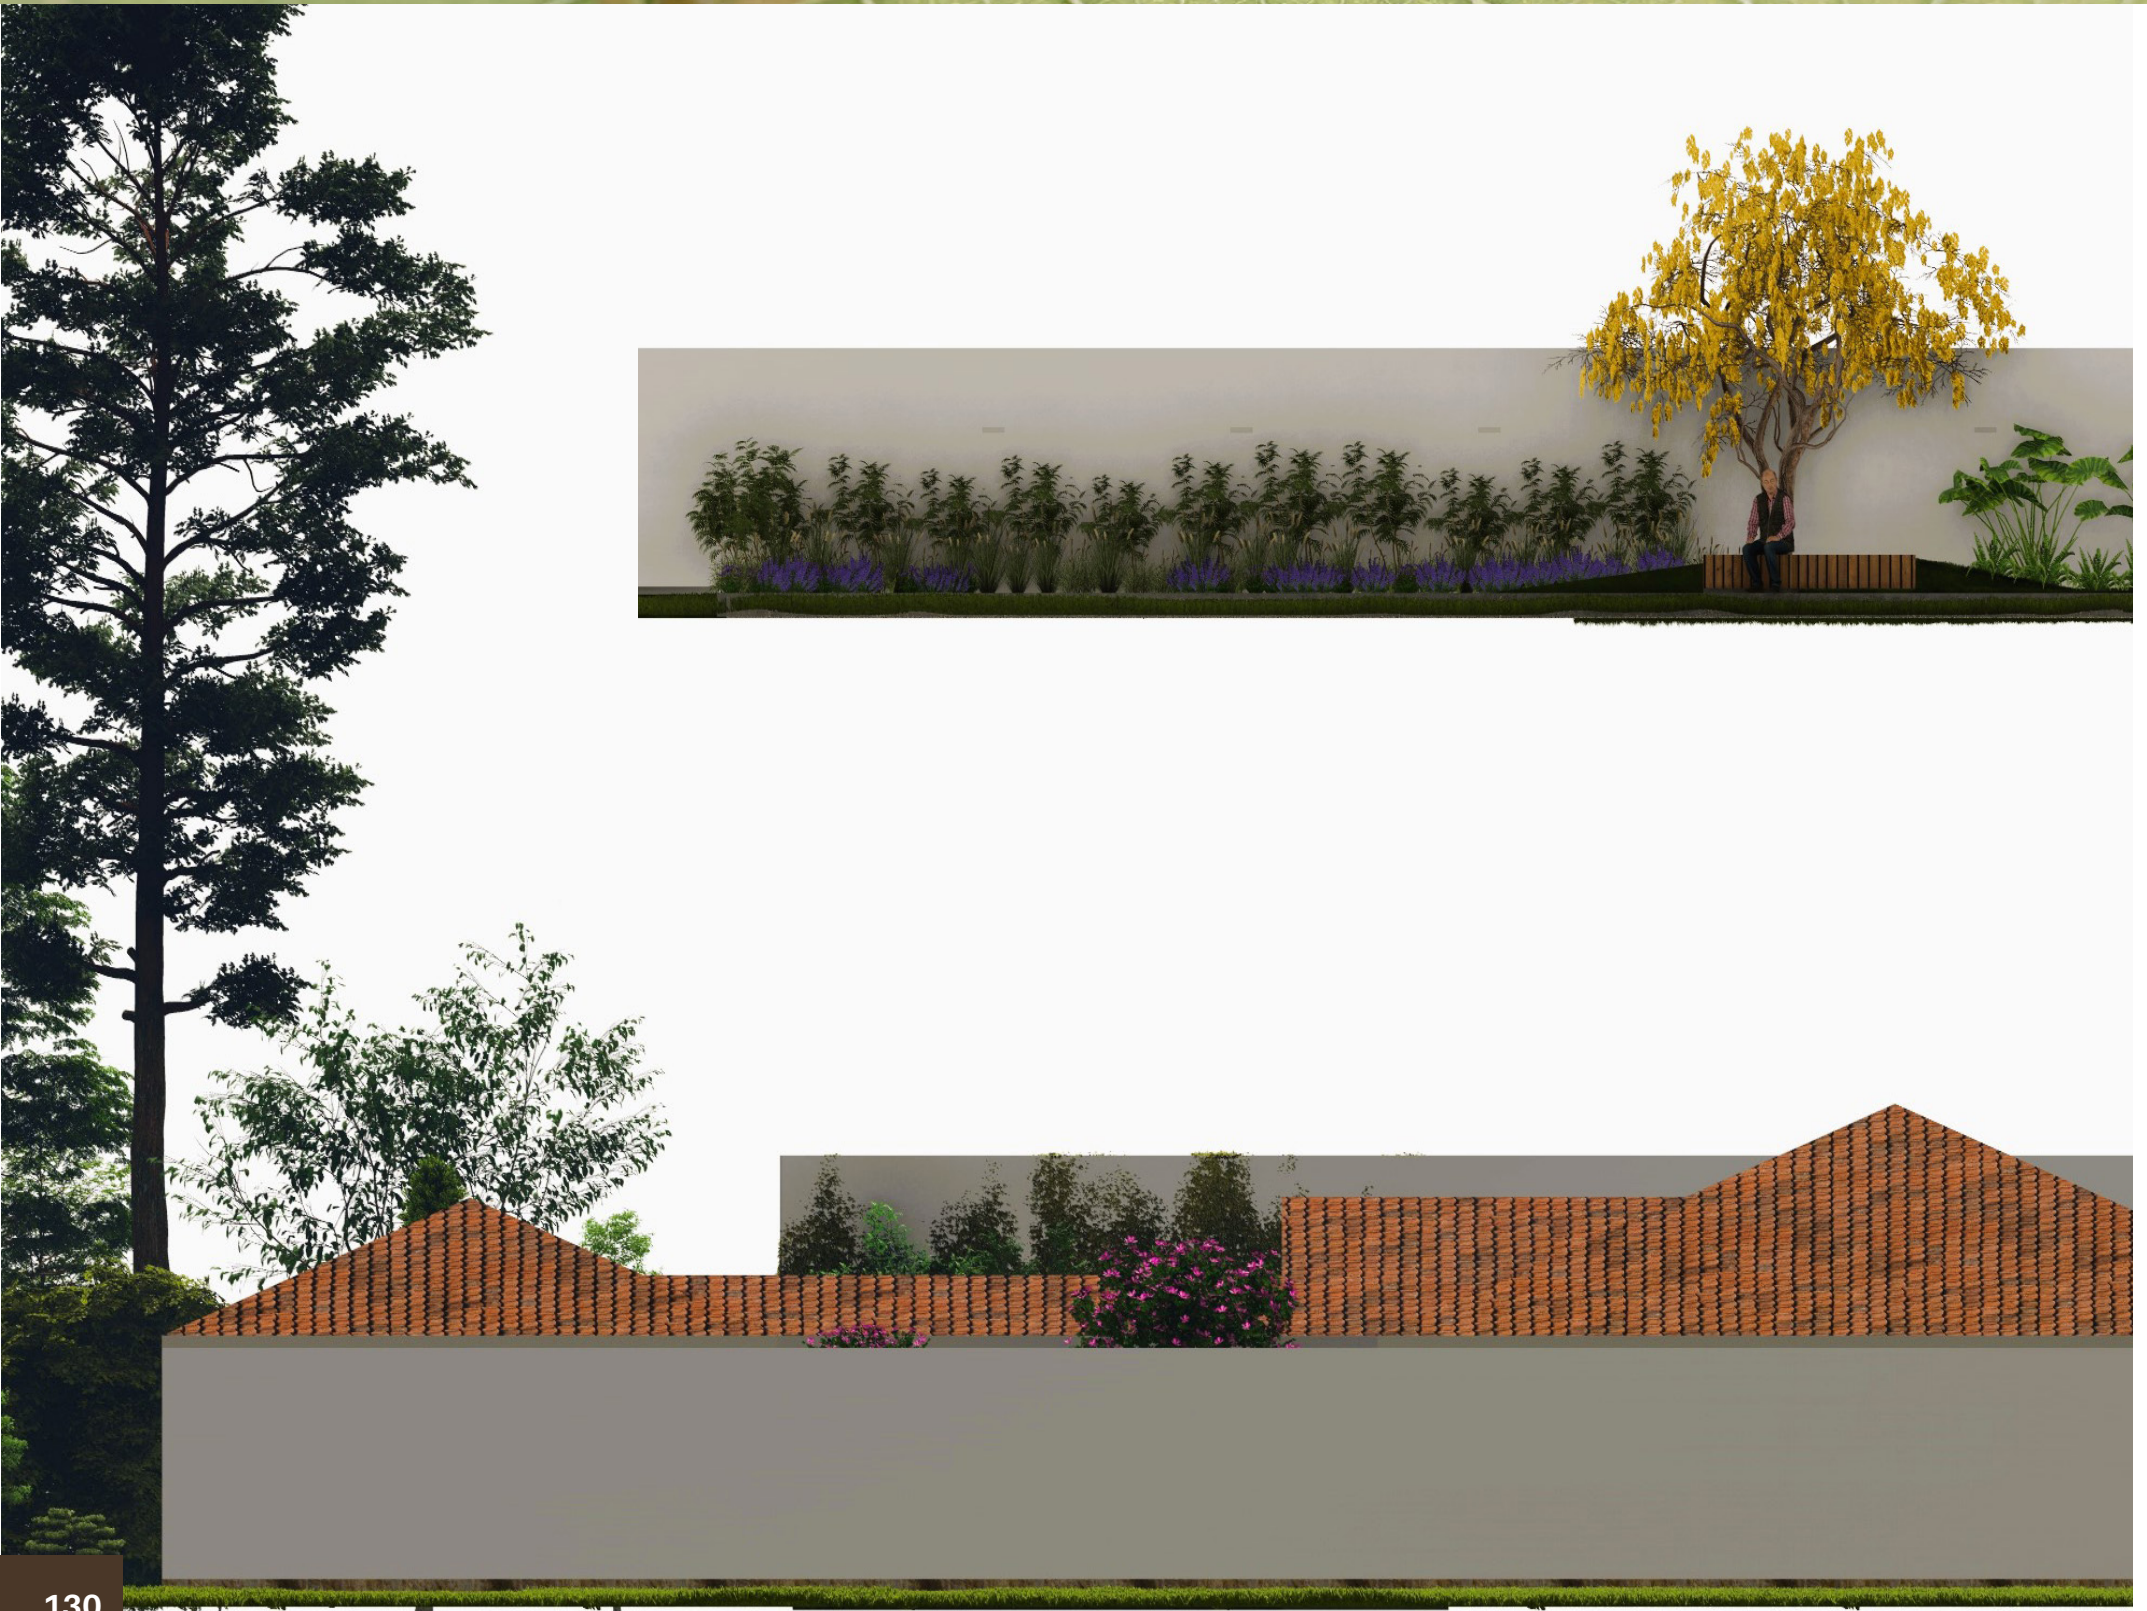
Corte longitudinal.1 (Redrován, 2024).
